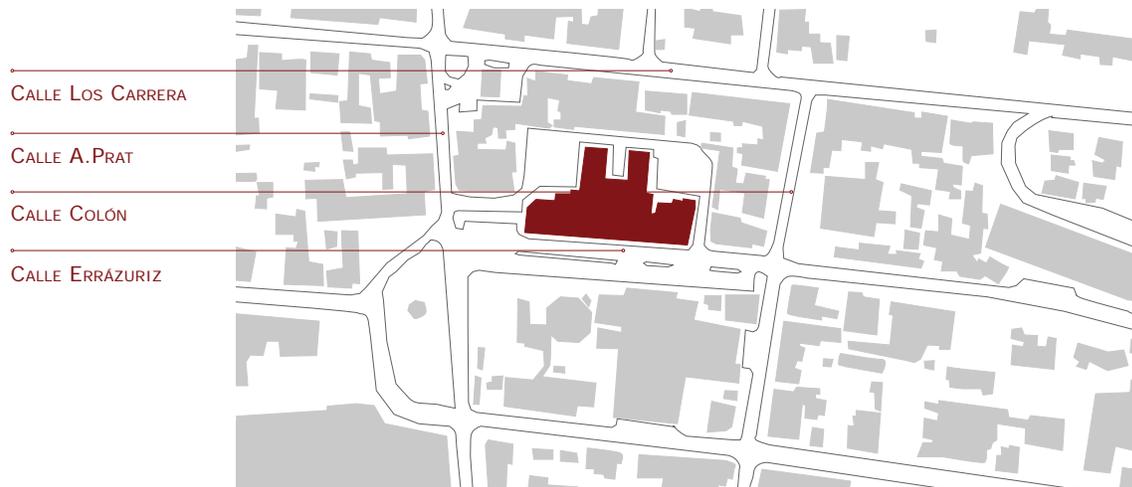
PLANO DEL EMPLAZAMIENTO DEL MERCADO.
